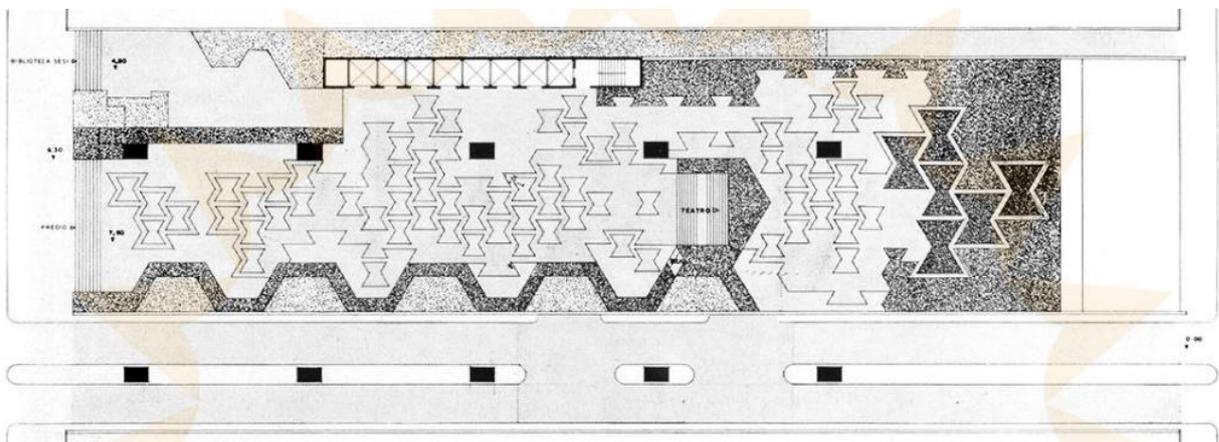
Planta do pavimento térreo superior – praça 'semipública' com paisagismo de Burle Marx
